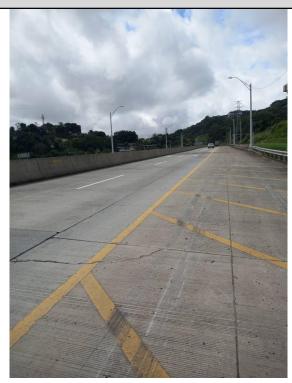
Falla de pavimento rígido en el intercambiador vial Brisas del Golf
